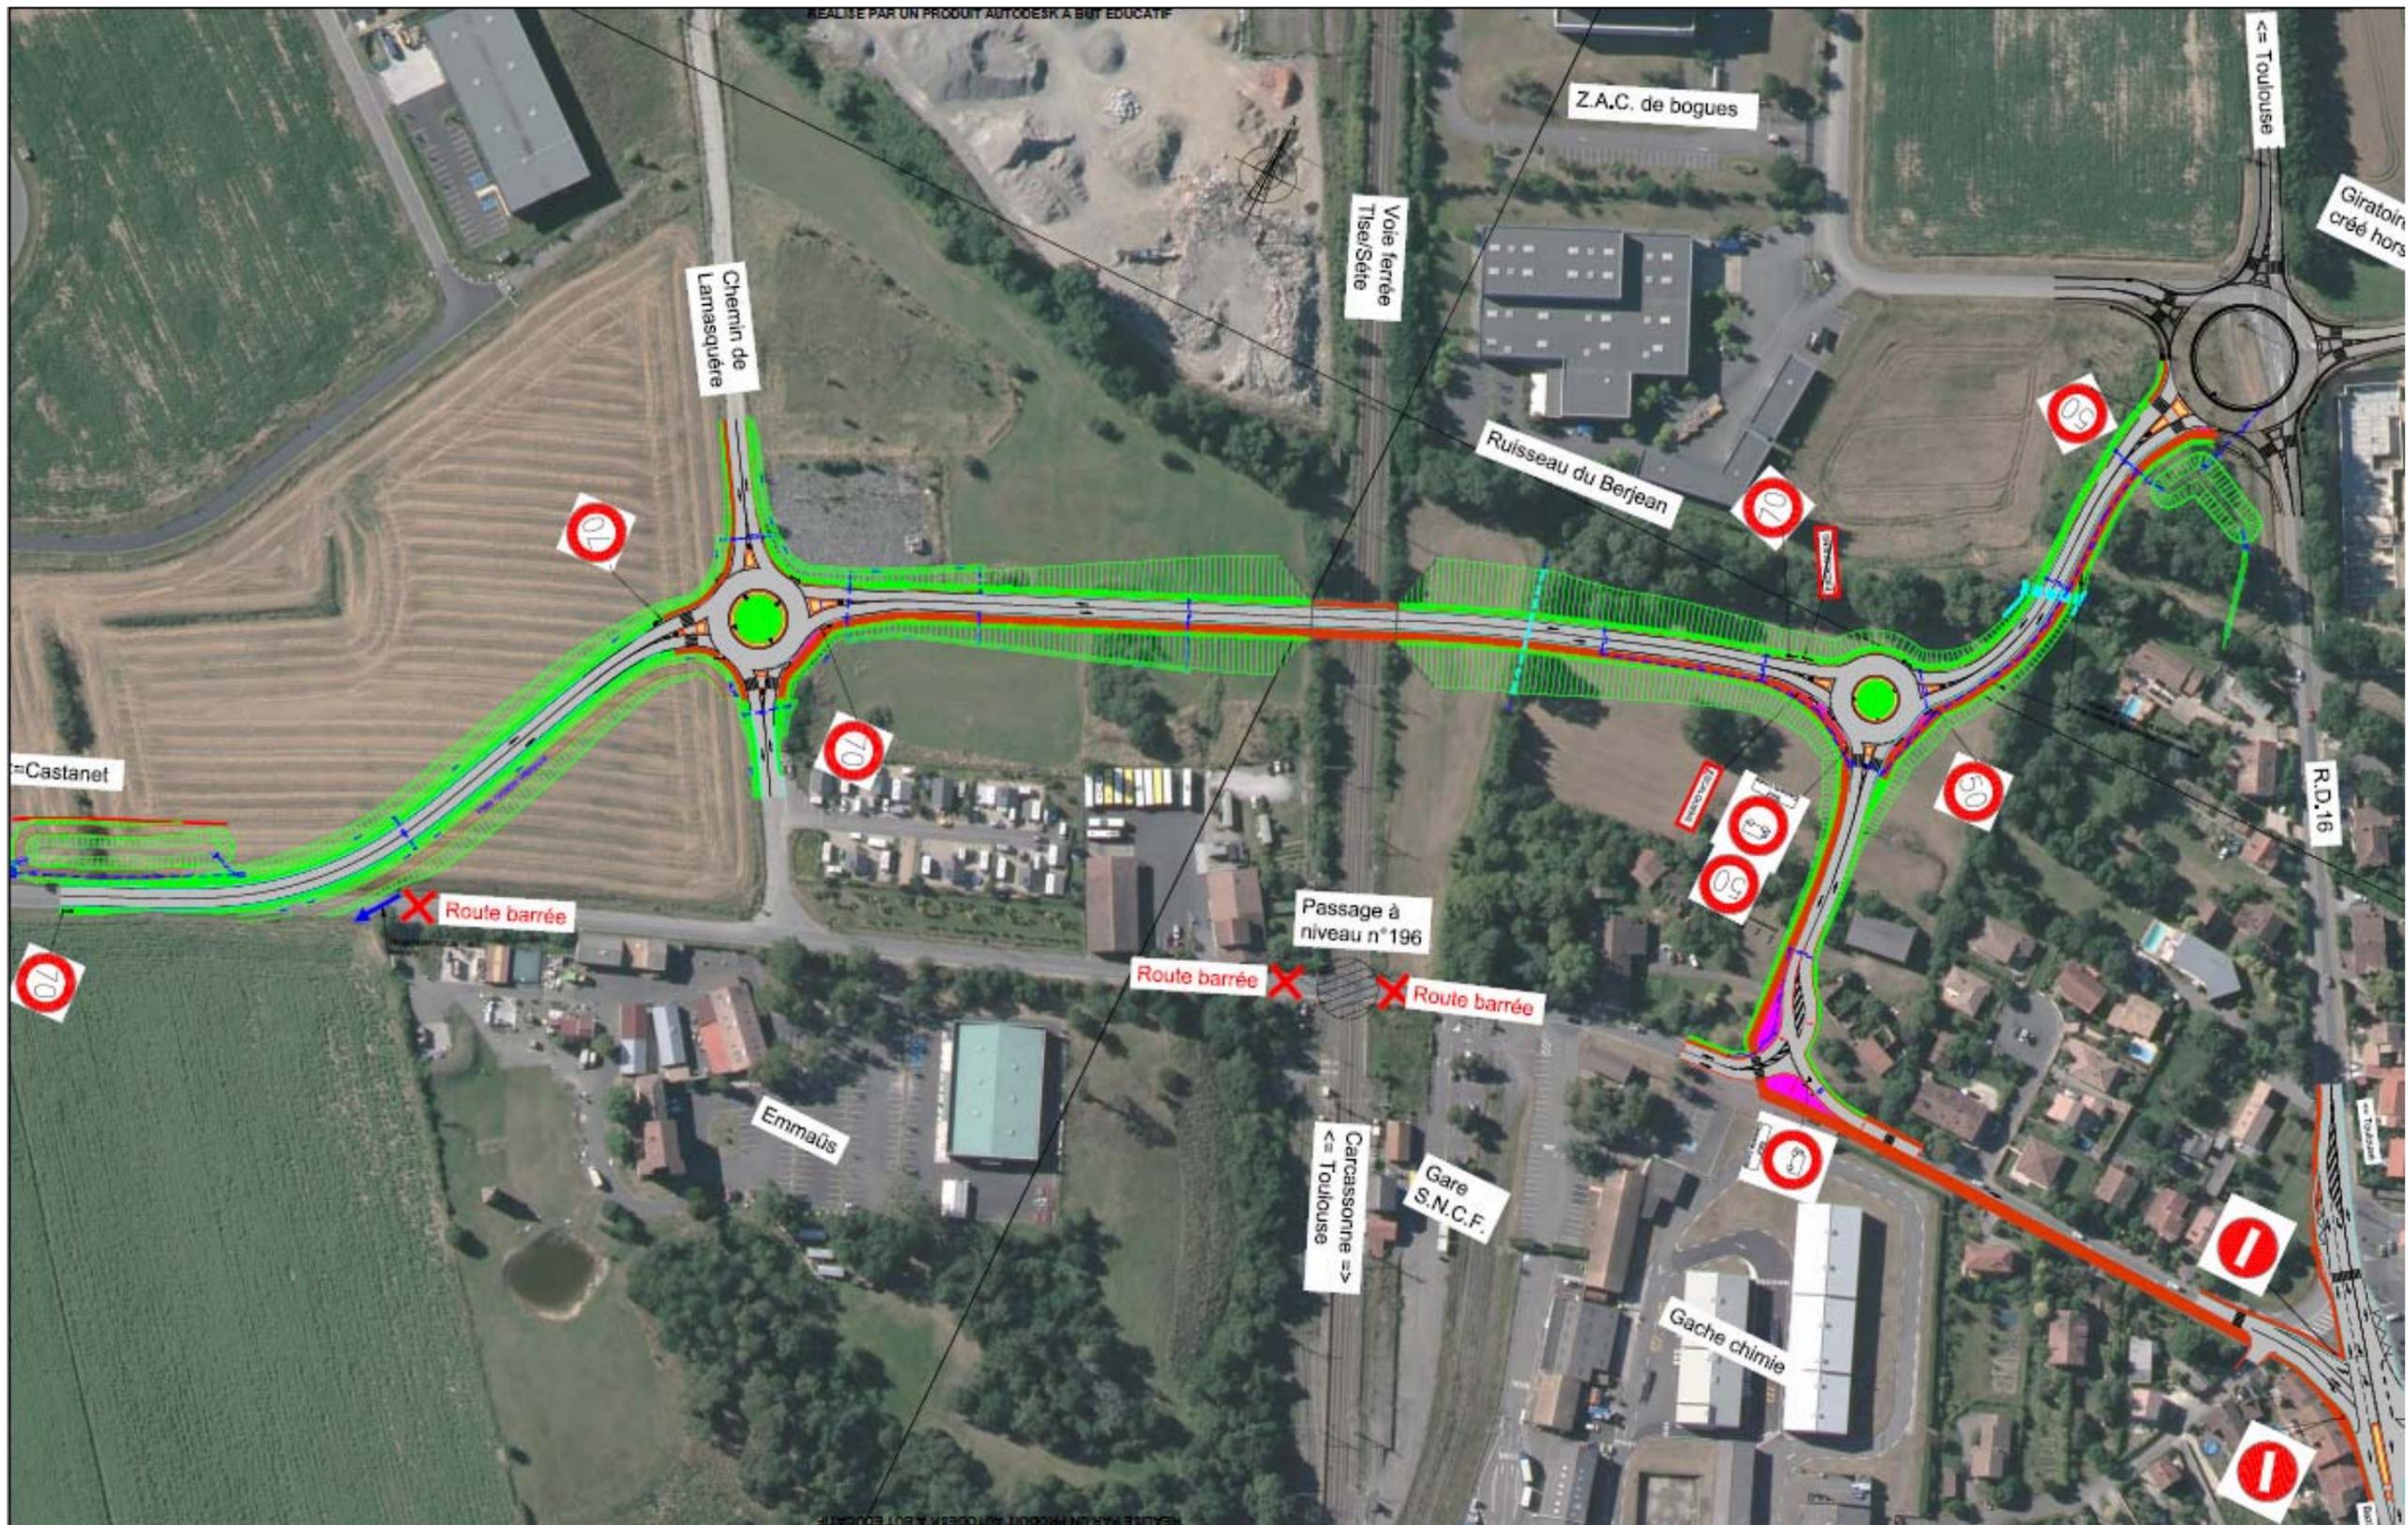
Plan du projet retenu issu d'une amélioration de la variante longue 2.
